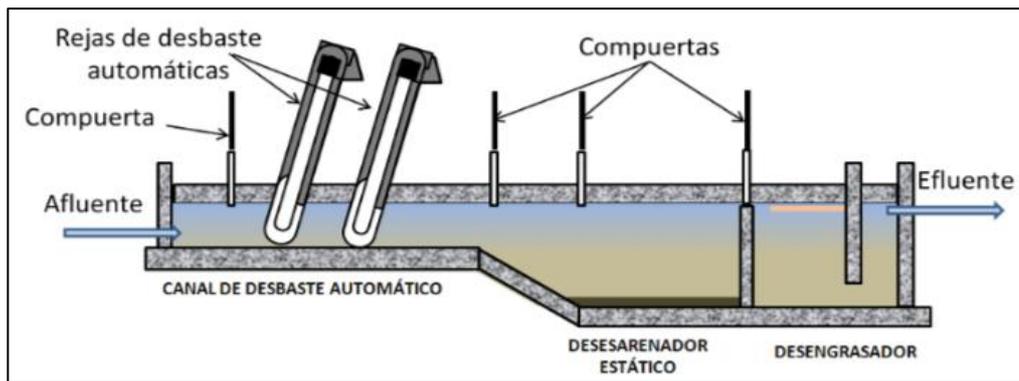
Esquema de pretratamiento con elementos de limpieza automático-manual
